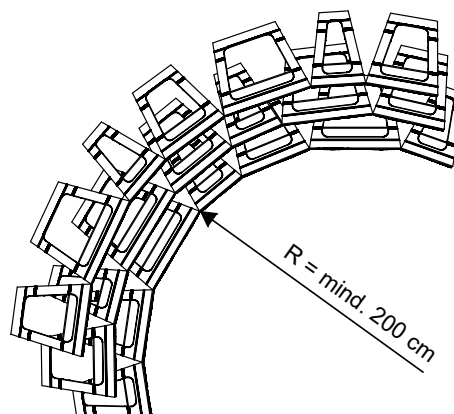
Grundriss Innenkurven mit Rücksprung 16,5 cm
